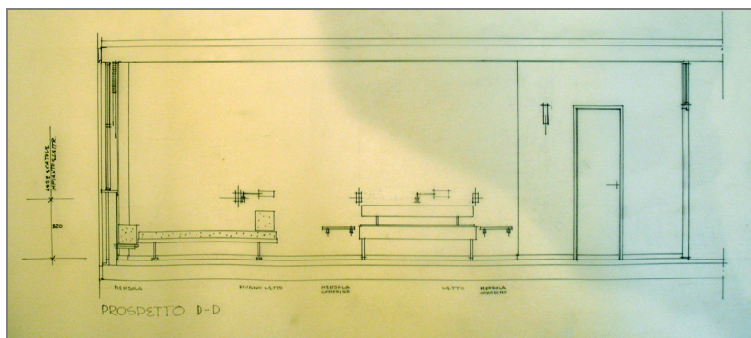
camera tipo, prospetto DD (fonte CSAC – stralcio tav. 33, archivio n. 276-1)
